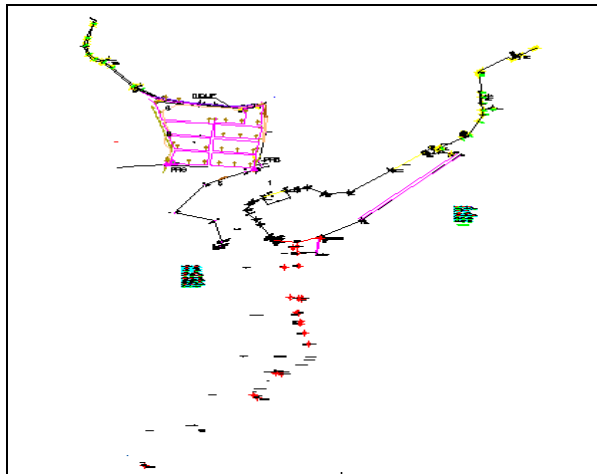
Levantamiento en planta de secciones a construir tanto aguas arriba como aguas abajo del puente. (AUTOCAD 2010)
